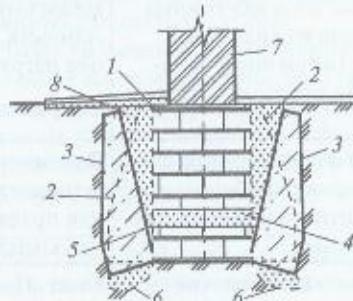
Уширение опорной площади ленточных фундаментов установкой сборных железобетонных элементов:
